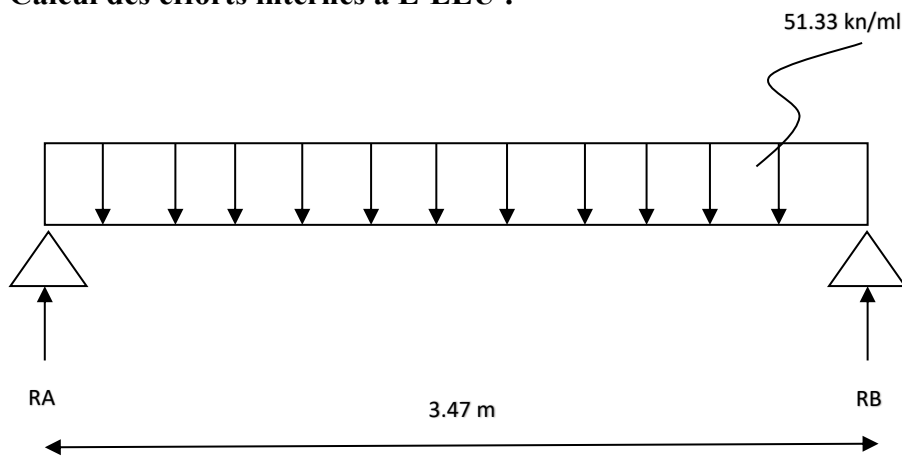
schéma statique de la poutre palière a l'ELU
